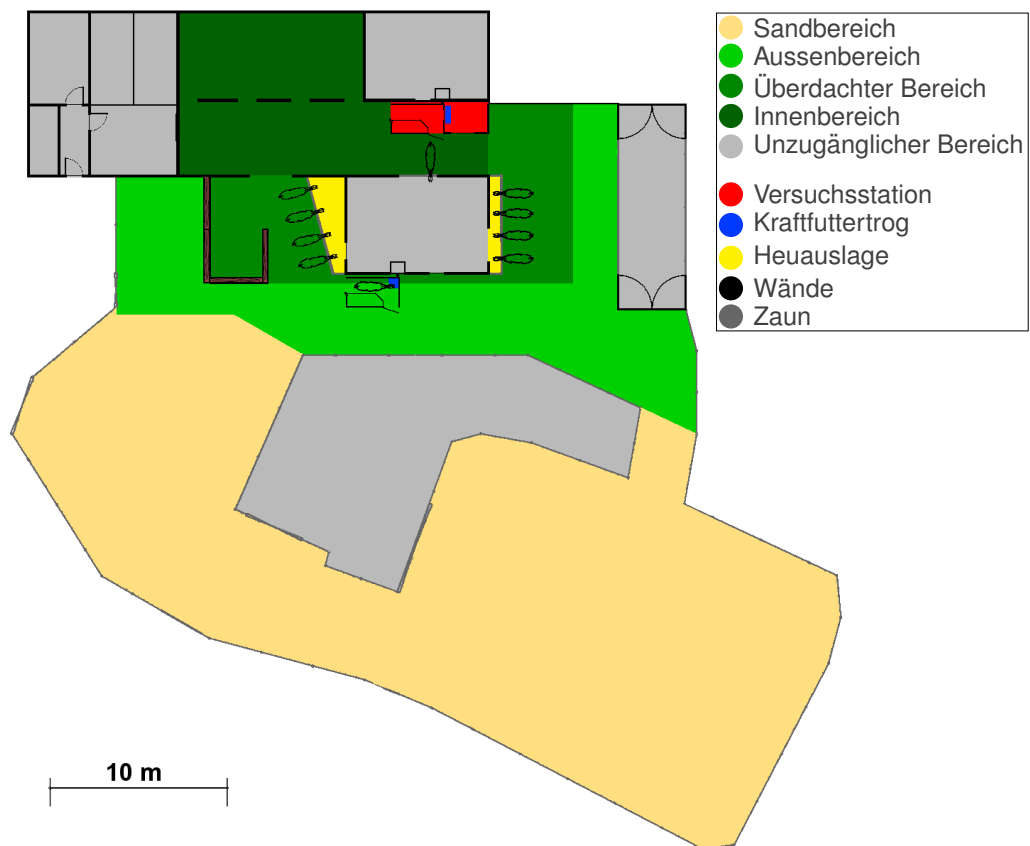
Offenstall Grundriss [Verändert nach: Hinrichs Innovation + Technik GmbH 2012]
